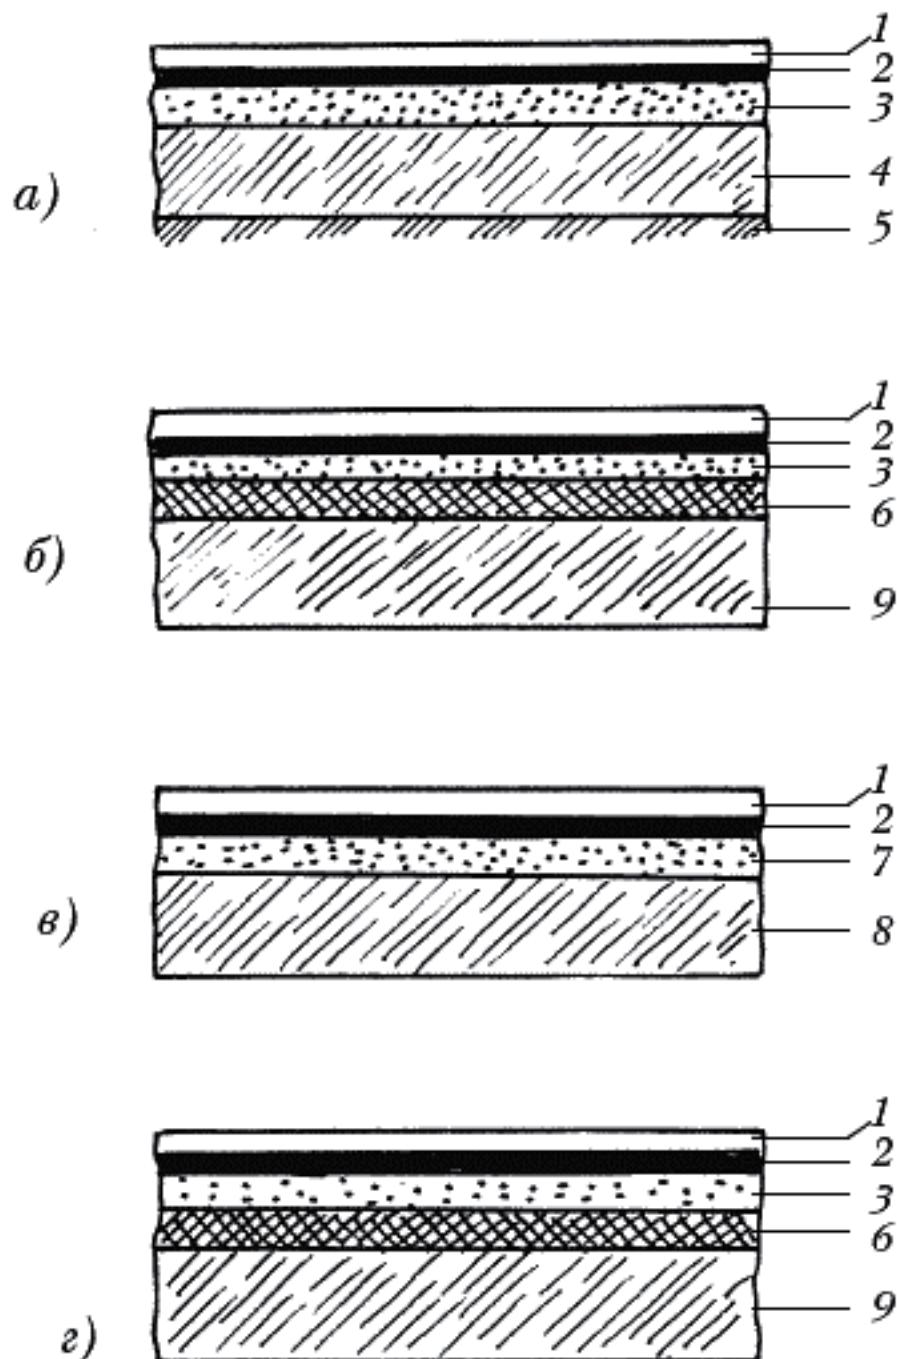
Варианты конструкции полов из линолеума: 1 – покрытие; 2 – мастика; 3 – стяжка из легкого бетона или древесно-волокнистых плит; 4 – бетонный подстилающий слой; 5 – грунт основания; 6 – тепло- и звукоизолирующий слой; 7 – цементно-песчаная стяжка; 8 – плита перекрытия с неровной поверхностью; 9 – плита перекрытия
